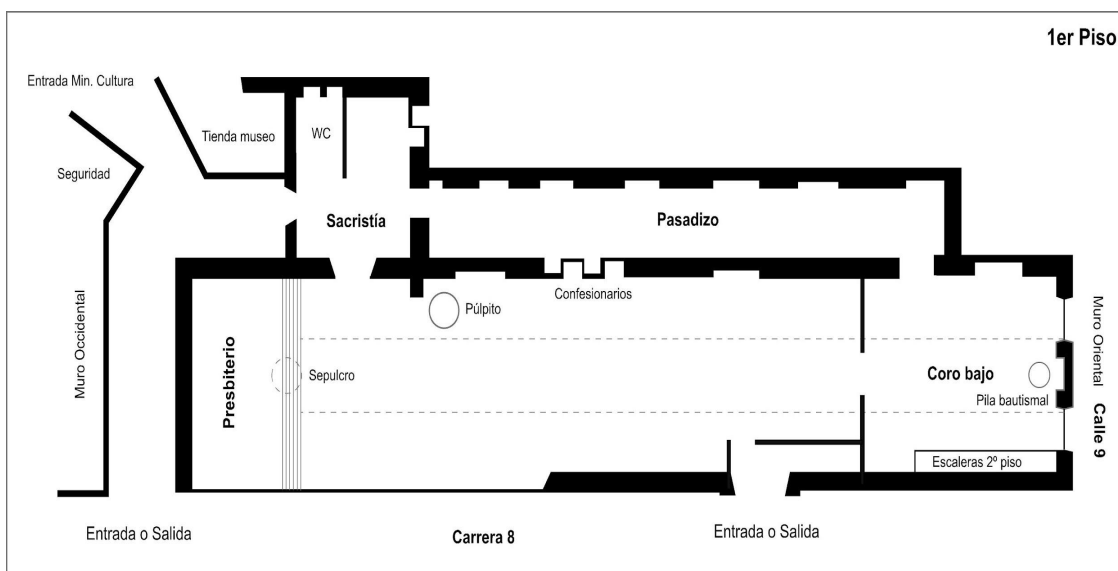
Plano de la planta baja del Museo de Santa Clara.
